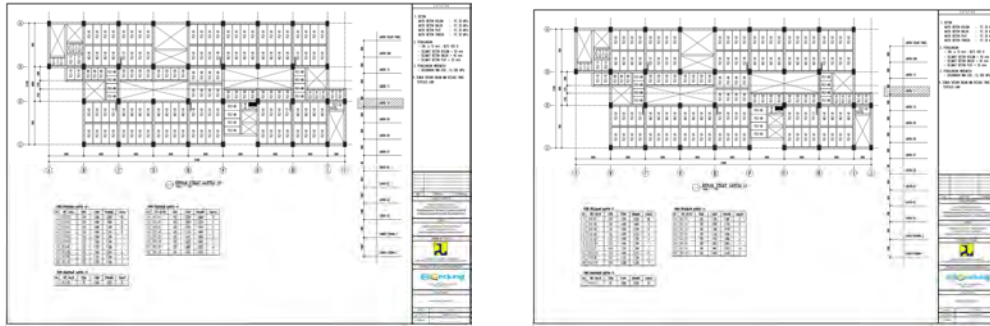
13 Detail struktur kolom lantai 4 dan 5
